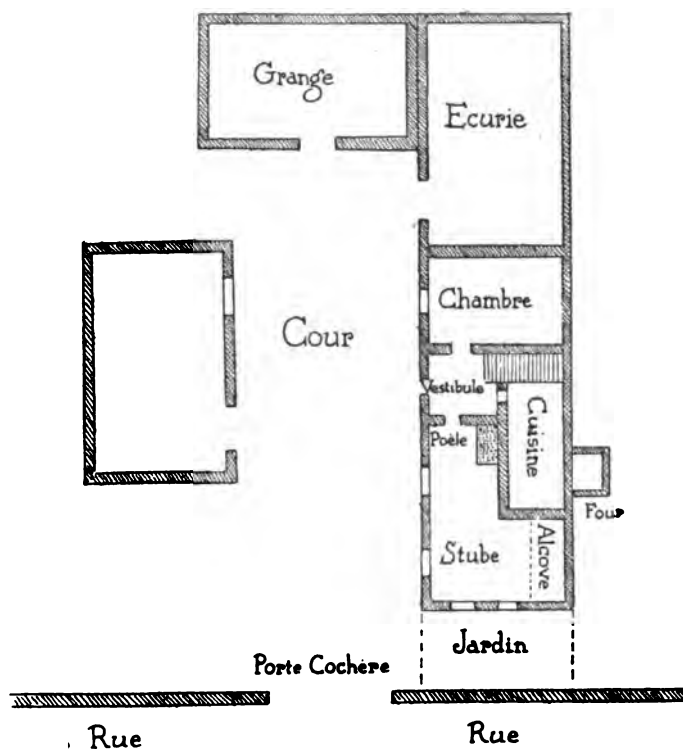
PLAN TYPIQUE DE LA MAISON ALSACIENNE.
